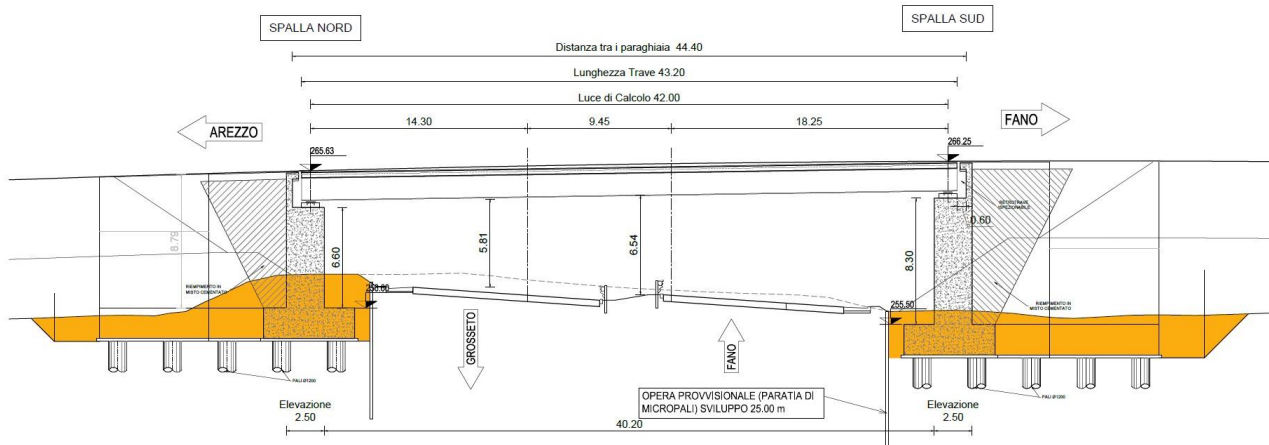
Sezione longitudinale Cavalcavia CV03
